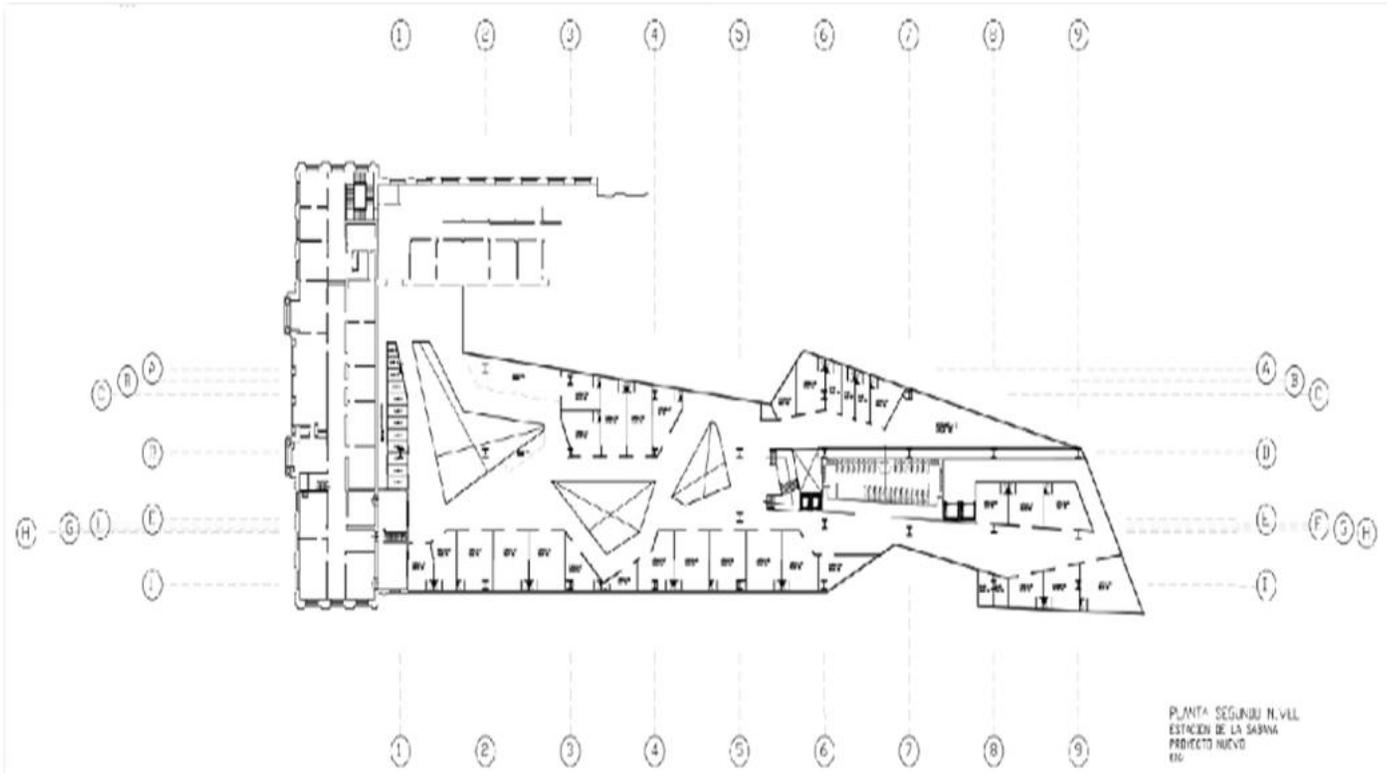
Planta Segundo nivel proyecto nuevo. Estación de la Sabana.
